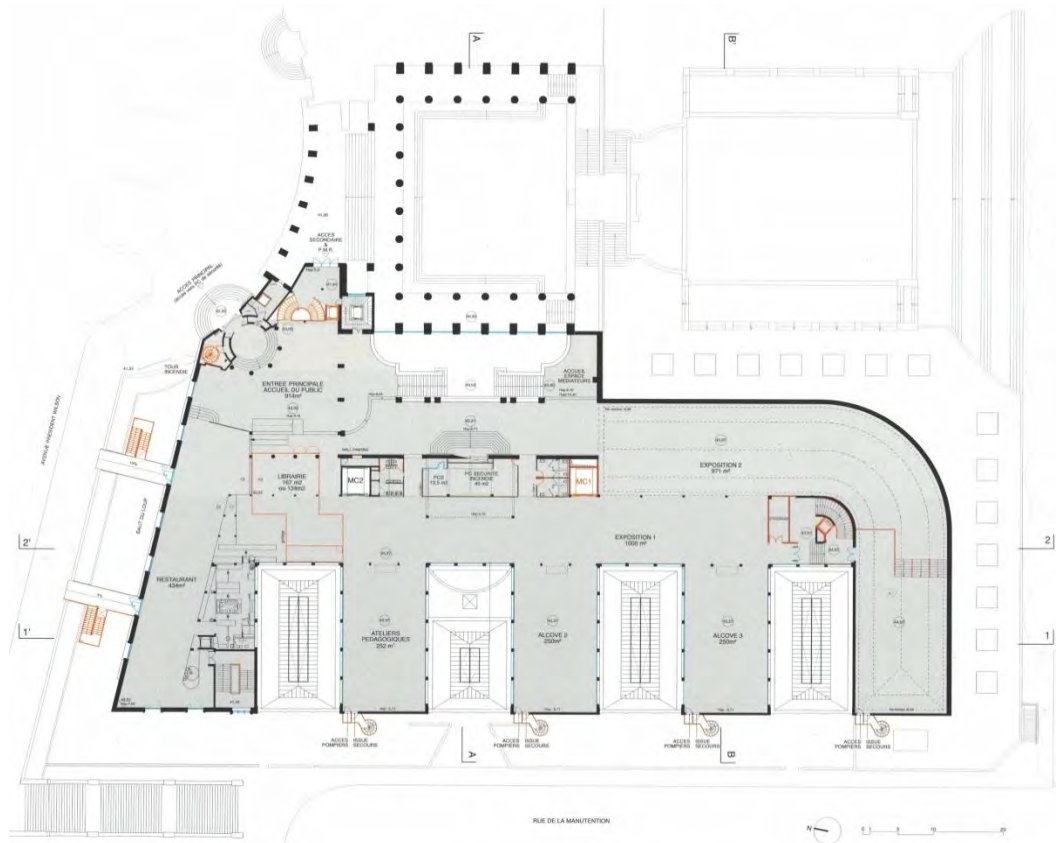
Palais de Tokyo, 2012. Planta baja. Nivel 2
